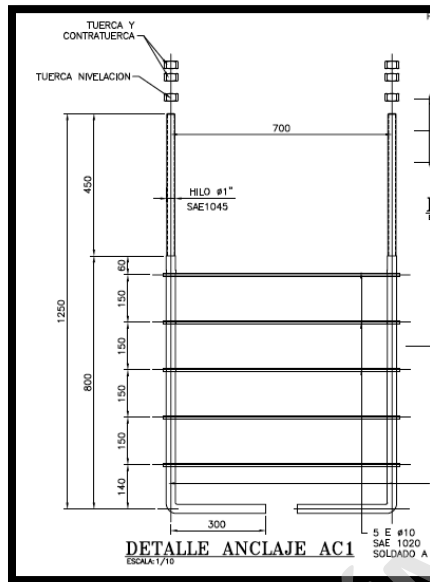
Planta de Anclaje ODR Ingeniería y Montajes
